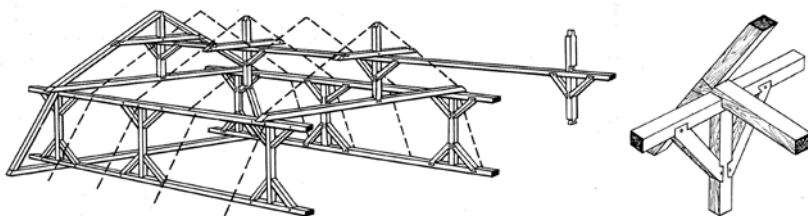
Конструкция мансардной крыши со стропильно-ригельными фермами с тремя подстропильными рамами (жилой дом в Несвиже, XVIII в.) и типичное для белорусского зодчества опирание ригеля на подстропильную раму
